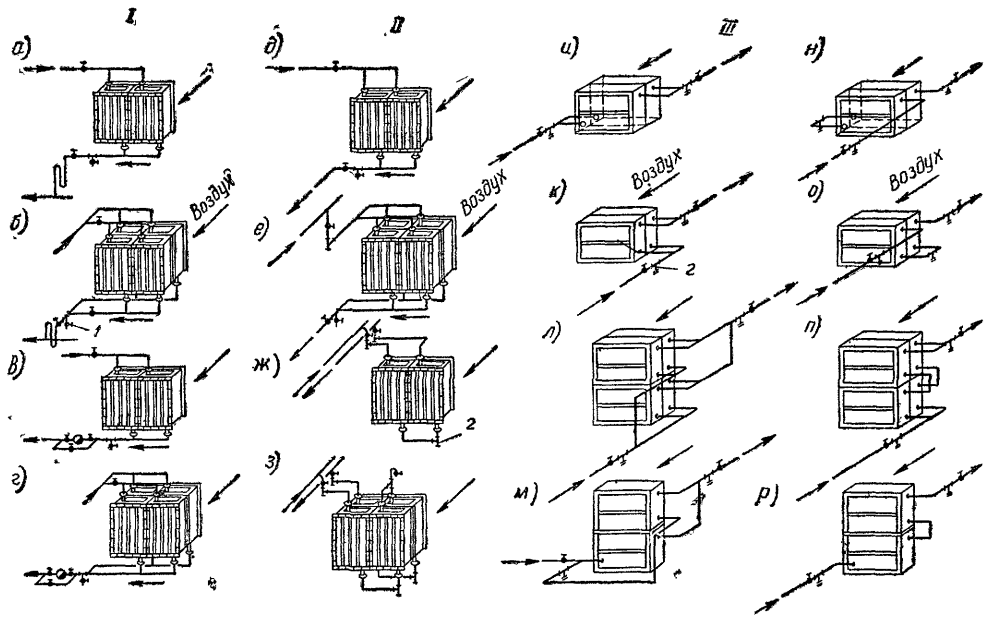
Схемы присоединения калориферов к трубопроводам
